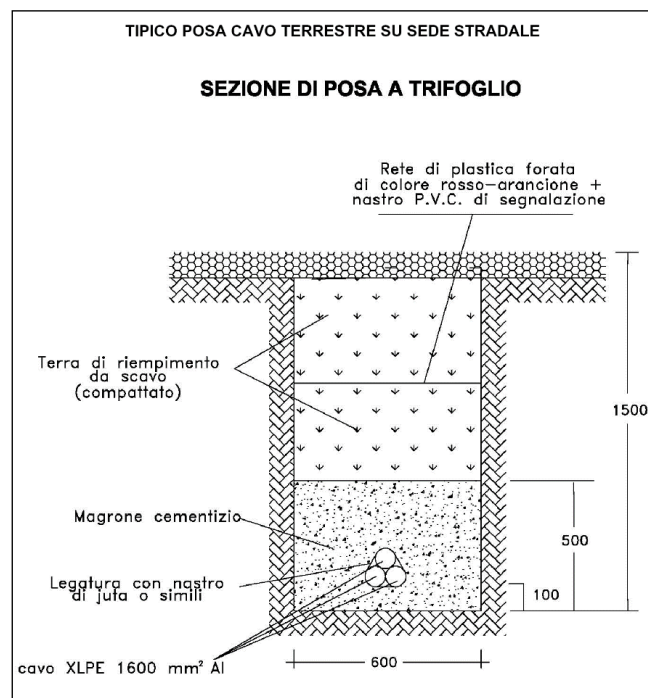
Tipico posa cavo terrestre su sede stradale
